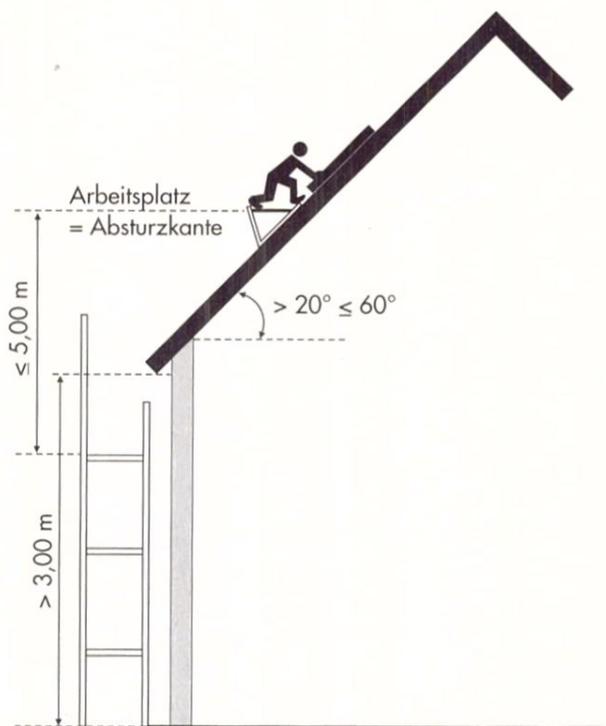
Dachfangerüste für Arbeiten auf geneigten Dachflächen.
